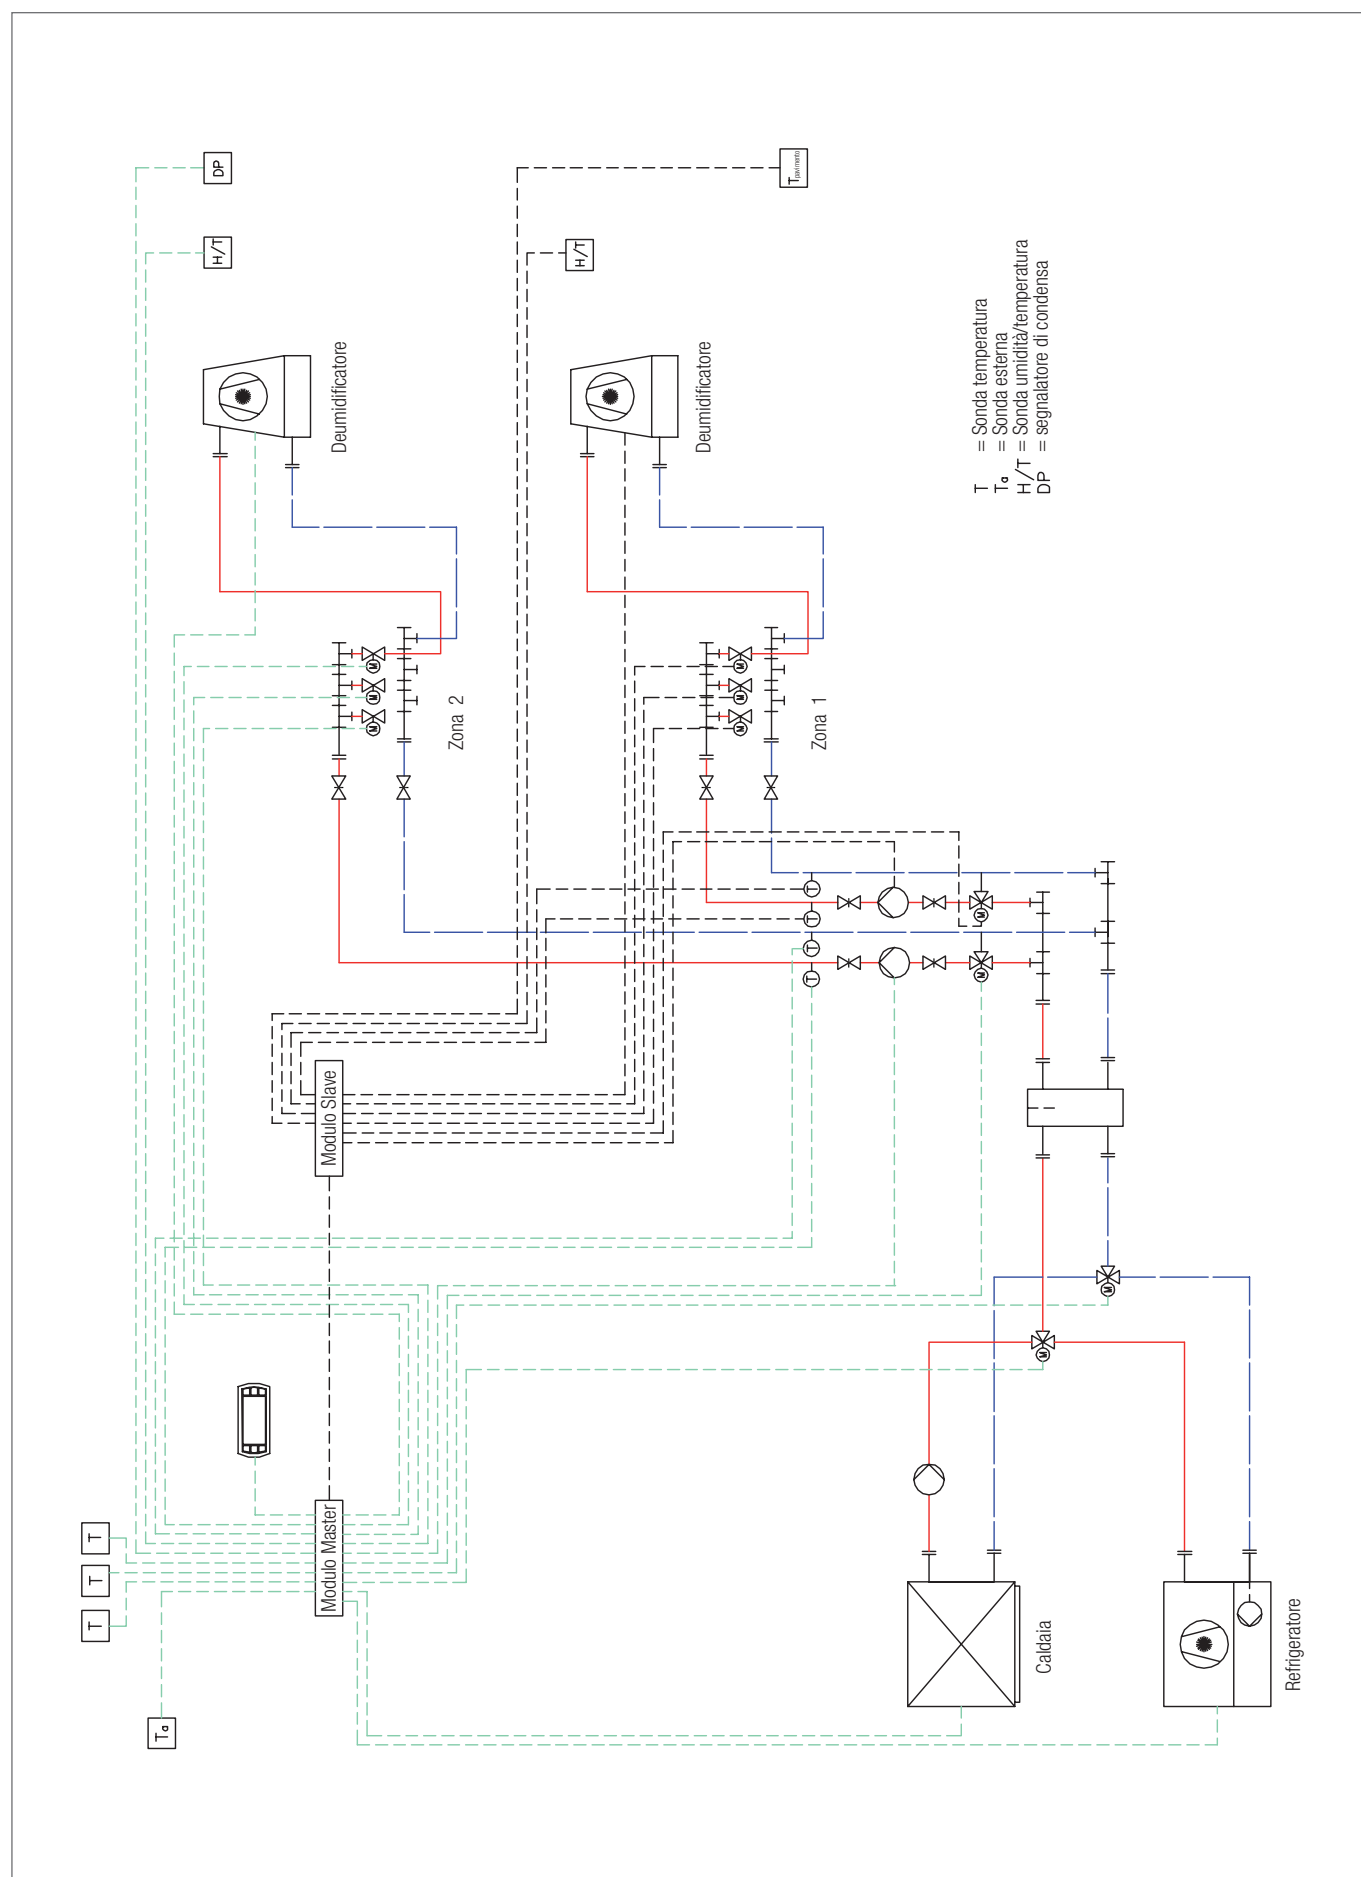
Sistema di riscaldamento/raffrescamento a pavimento, 2 zone
